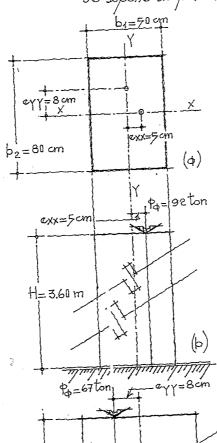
Planta de la columna mostrando la posición de las cargas excántricas, (a).
